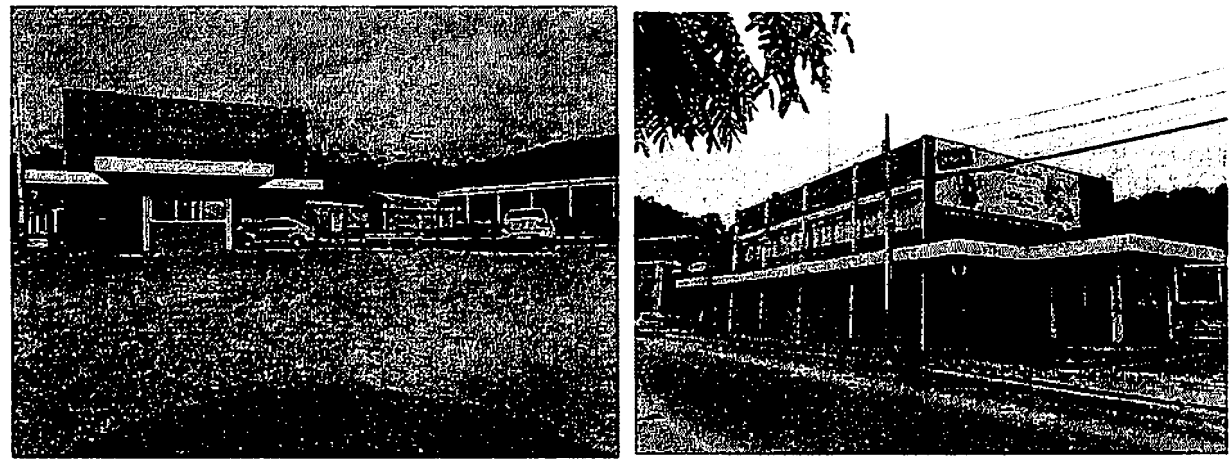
Fachada da unidade de Tecelagem, com frentes para Av. Primeiro de Maio.
